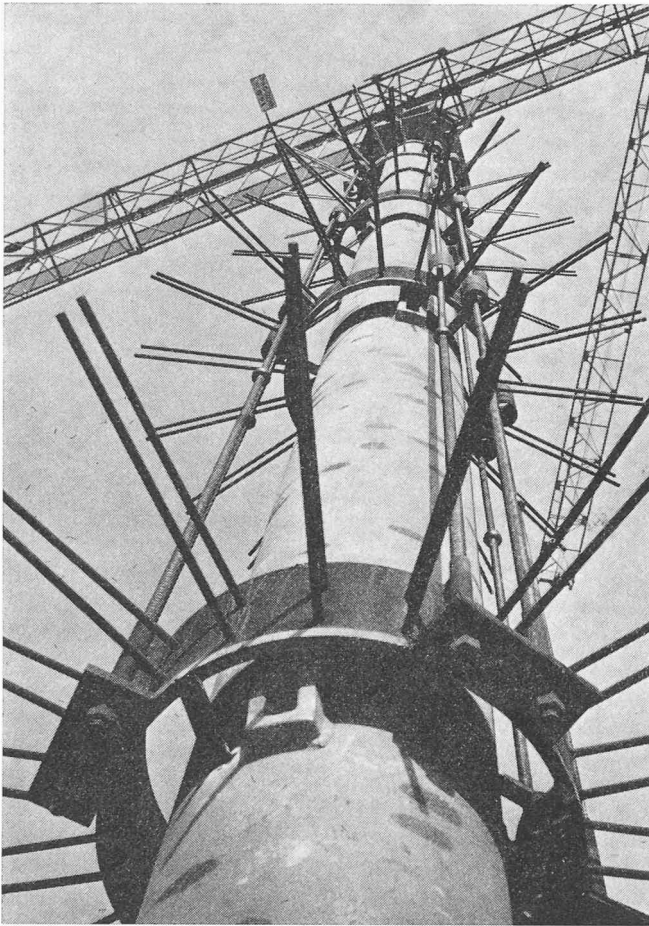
Probeweise aufgestellte Stahlrohrstütze mit Deckenaufleger. Das Stahlrohr, 58 mm Durchmesser, 12 mm Wanddicke, dient als Umschnürung des nachträglich eingebrachten Betons B 800
